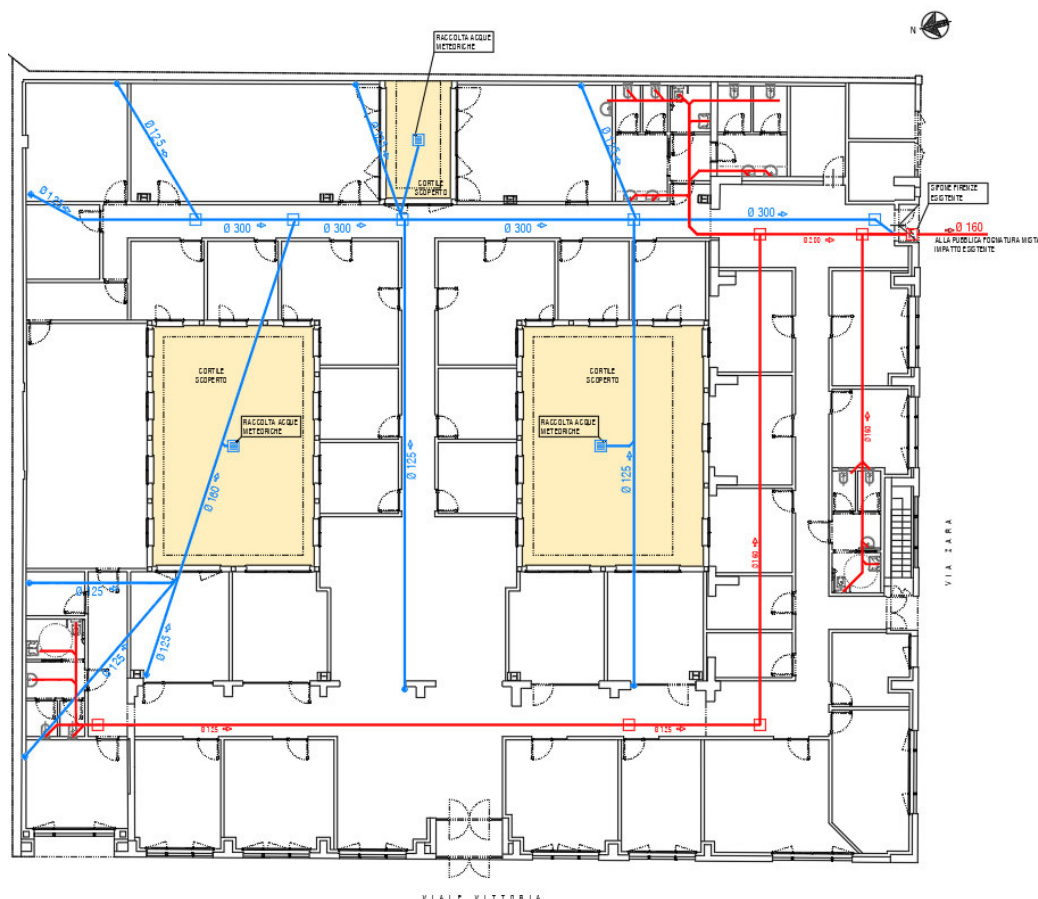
Planimetria delle reti fognarie nello stato di progetto.
